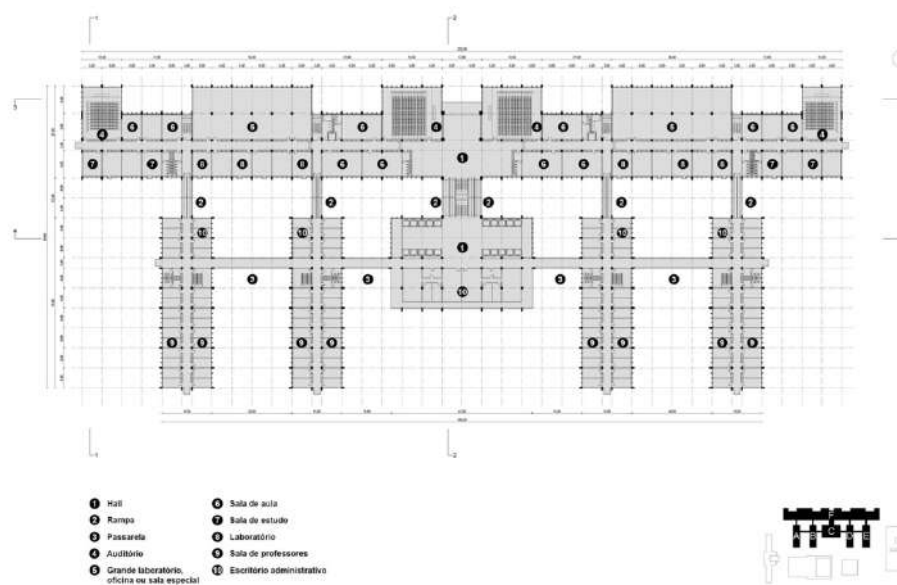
Pavilhão João Lyra Filho - Planta Baixa Pavimento Tipo.
